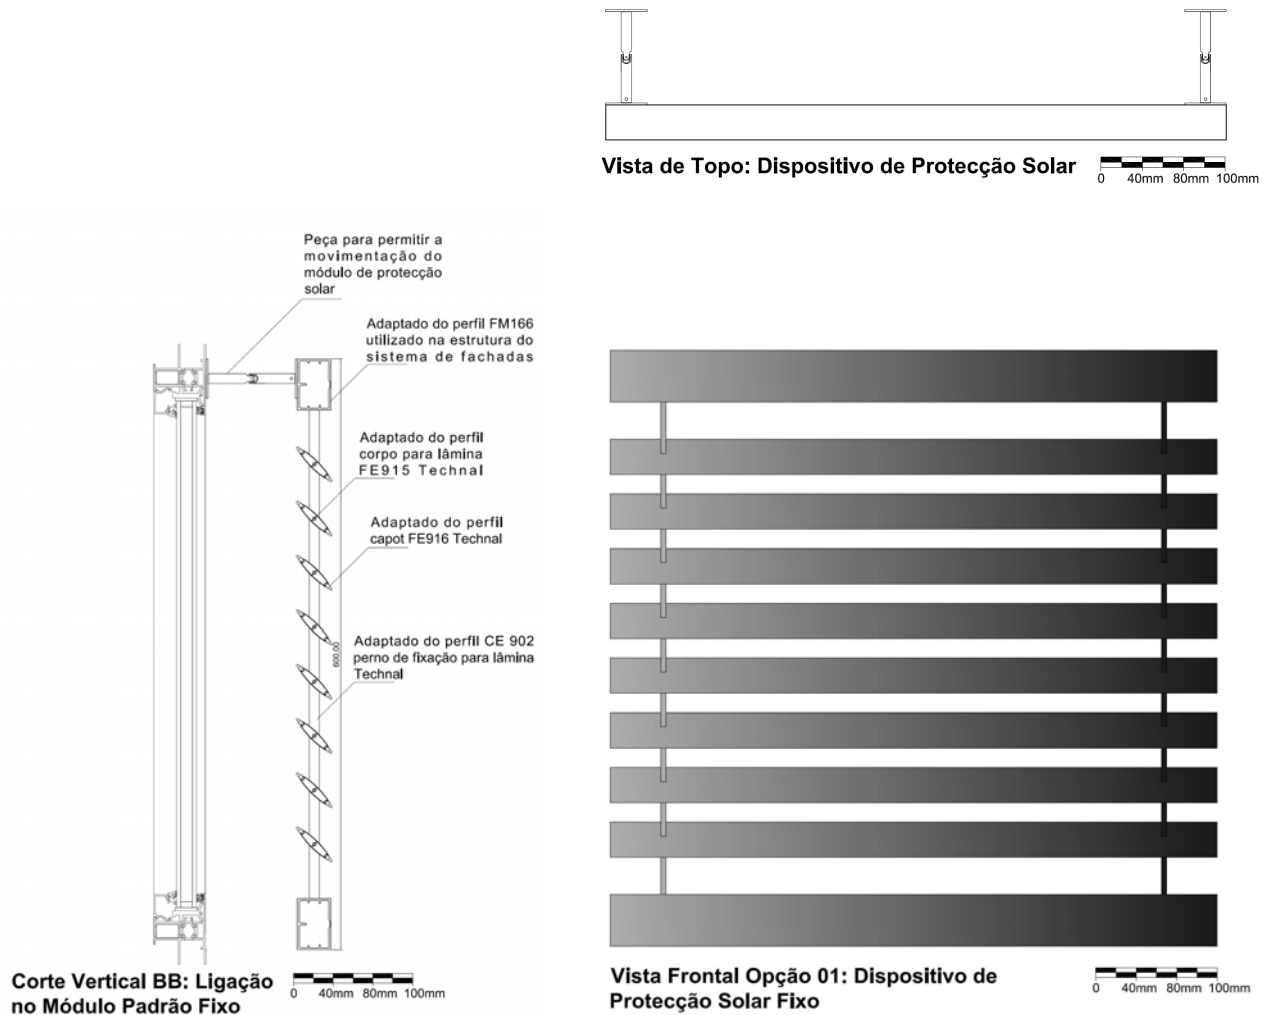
Corte e vistas do dispositivo de proteção solar.
